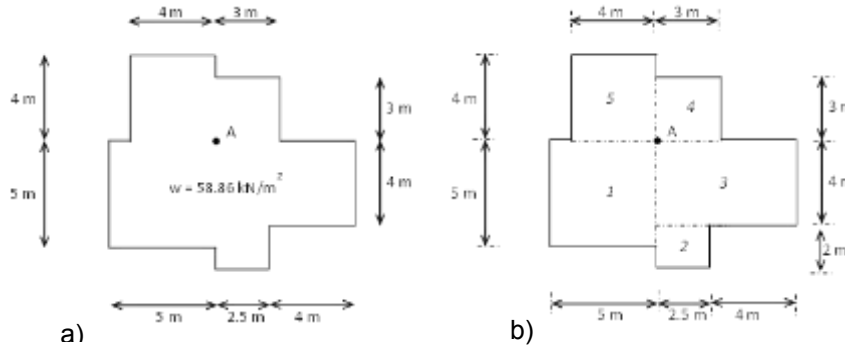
Planta de cimentación para el cálculo de esfuerzo vertical
